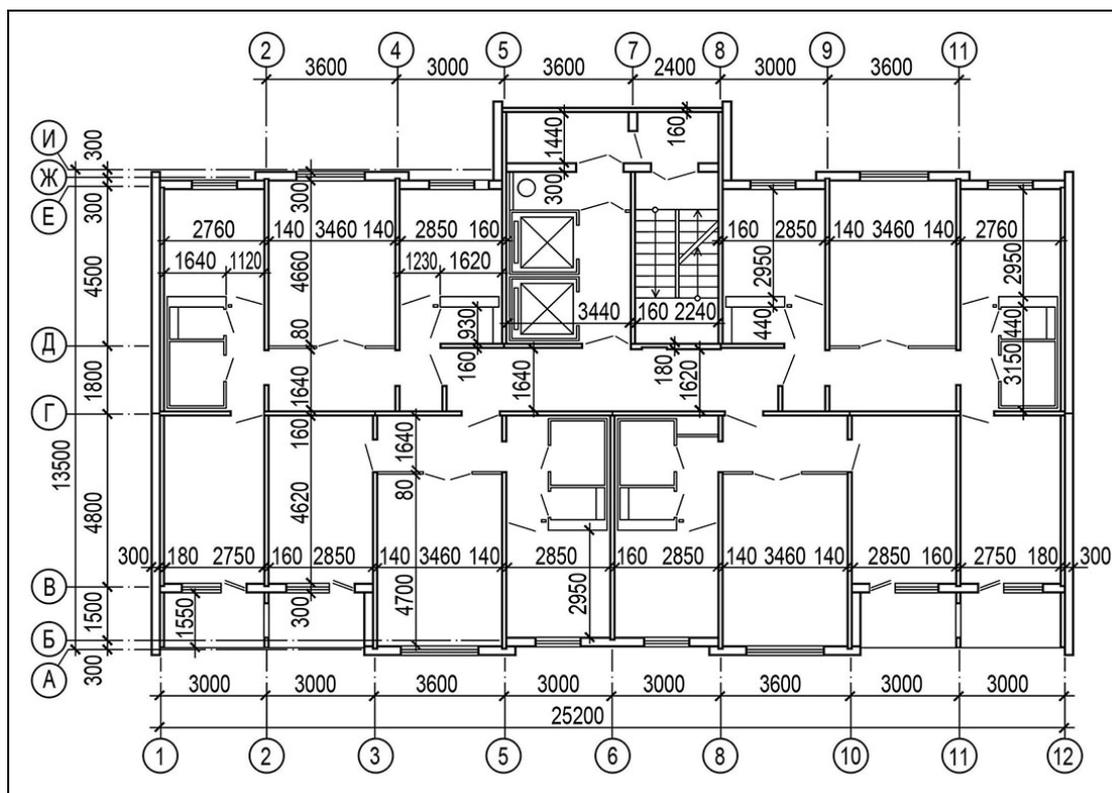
План типового этажа 12-этажного жилого крупнопанельного здания перекрестно-стеновой конструктивной системы с ненесущими (поэтажно опертыми) наружными стеновыми панелями
